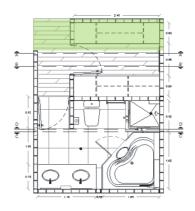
Diseño planta arquitectónica de baño y closet, departamento torre Mitikah. Elaboración conjunta, Álvarez, González, Hurtado. 2022
